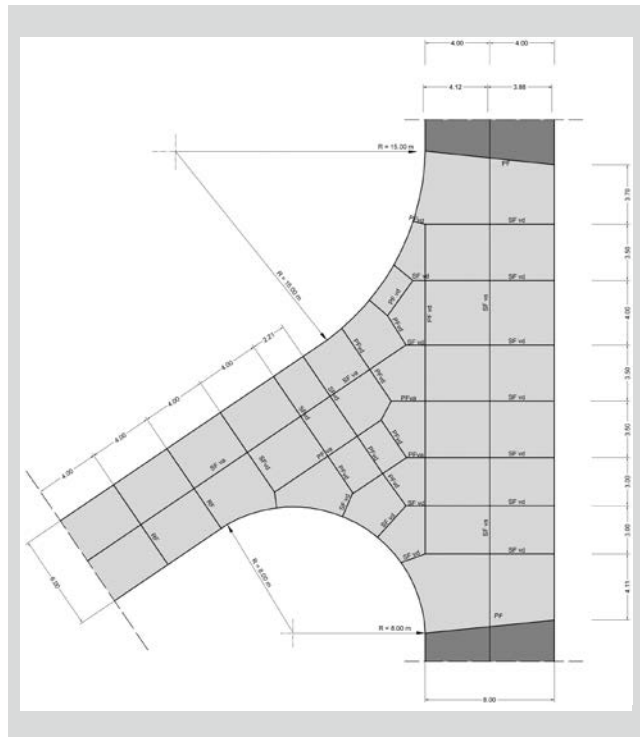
Beispiel Knotenpunkt einer Betonstraße mit Fugeneinteilung im Knotenpunktsbereich (Vollausbau in Betonbauweise)
